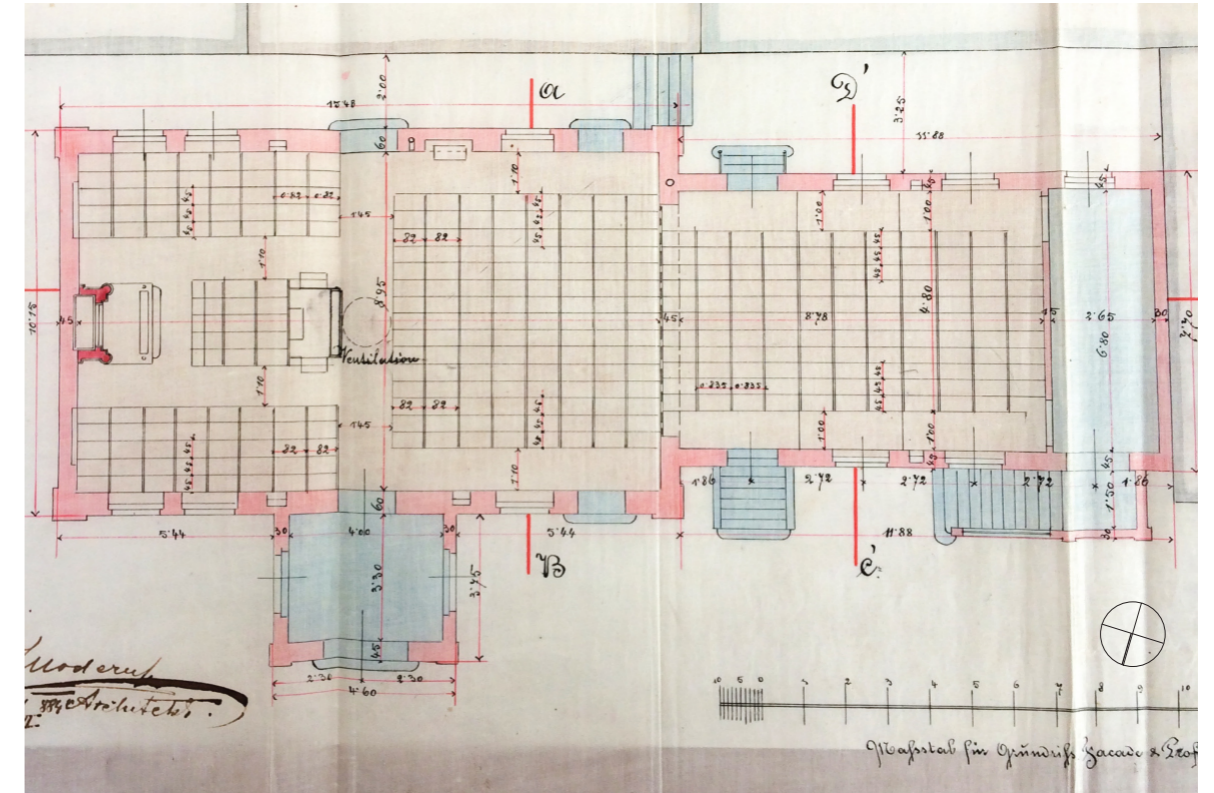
Grundriss Einreichung (1884) [ma37]
